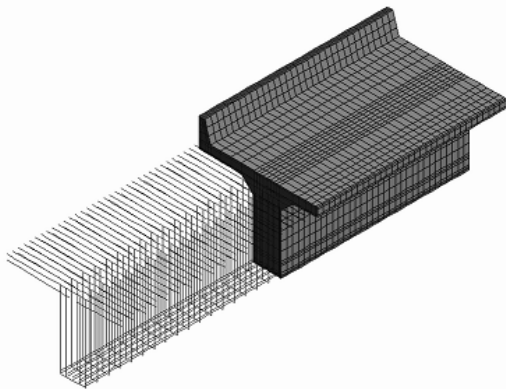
Конечно-элементная модель балки железобетонного пролетного строения
